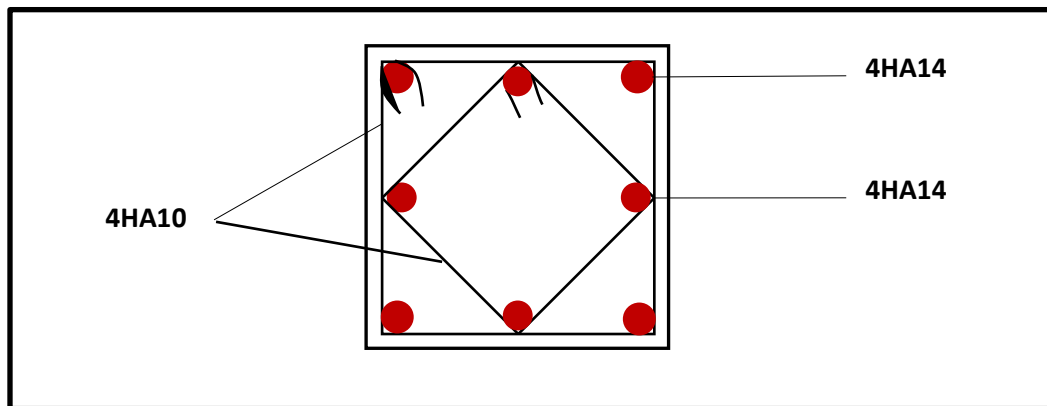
Schéma de ferrailage du poteau 40x40
